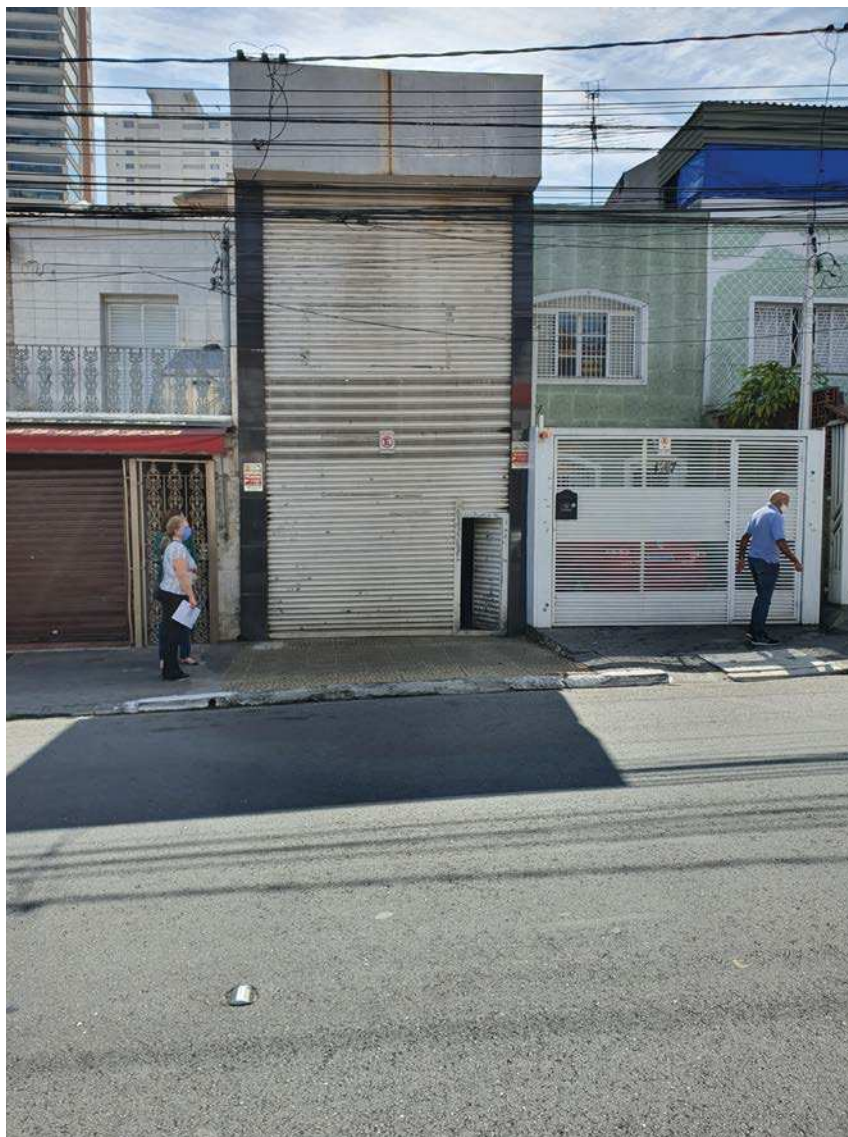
FACHADA FRONTAL DO IMÓVEL.
